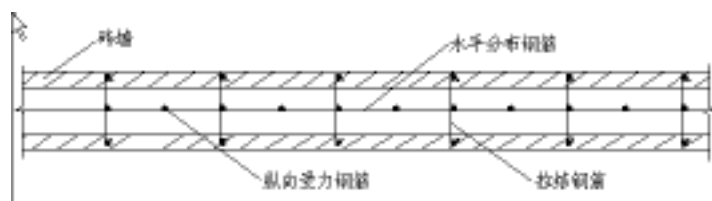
钢筋混凝土填心墙构造做法
